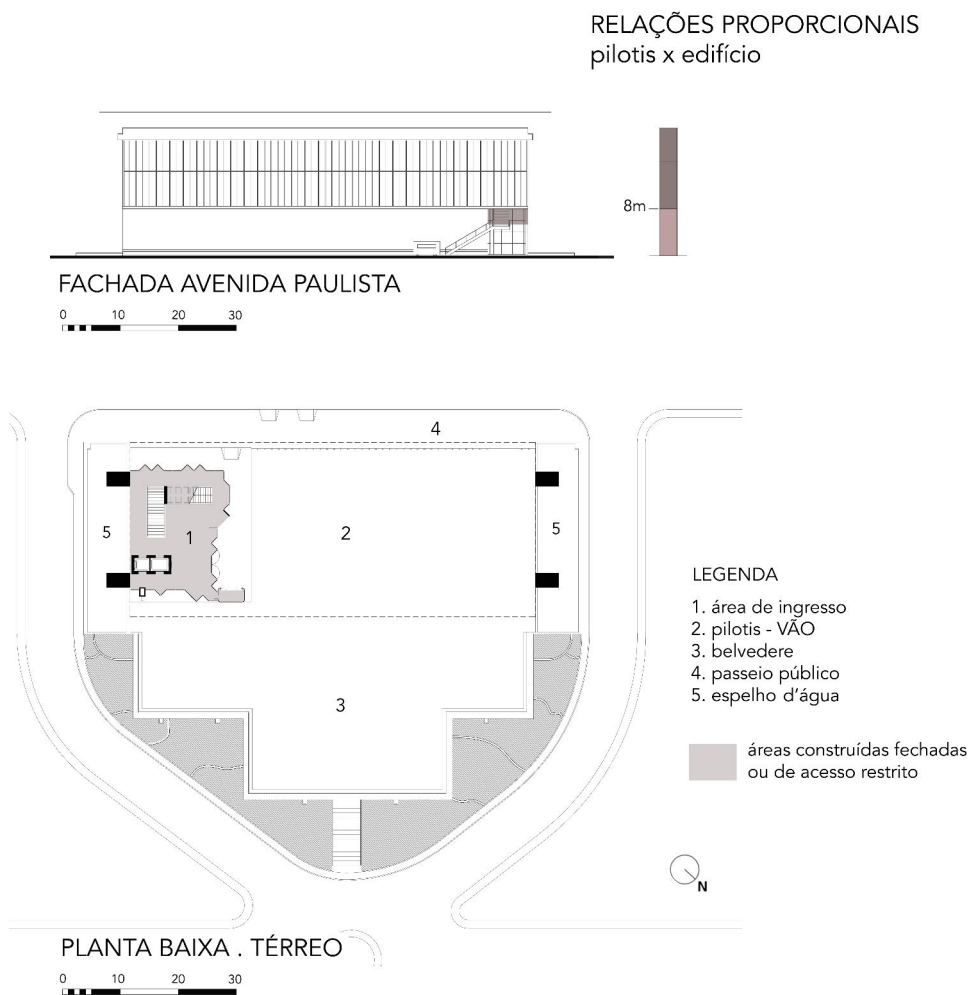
Plantas baixas do nível térreo com pilotis e fachada da Avenida Paulista. Fonte: edição da autora desenho Acervo MASP, 2021.
